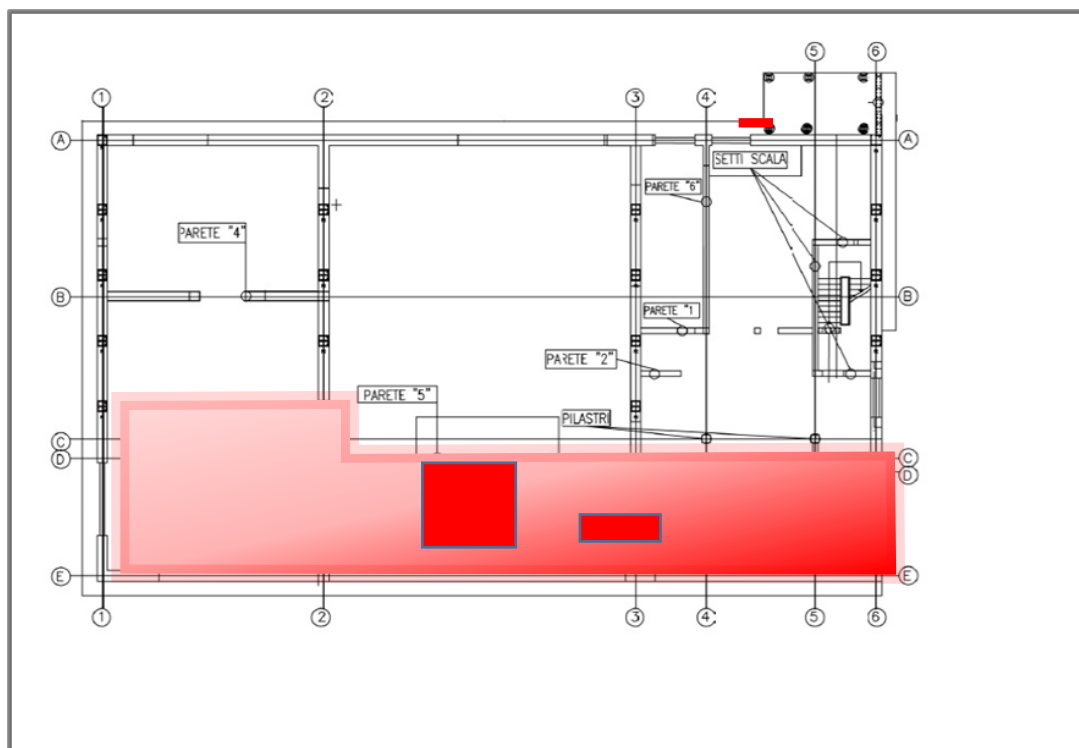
Planimetria di progetto con indicazione (in rosso) dei getti strutturali
